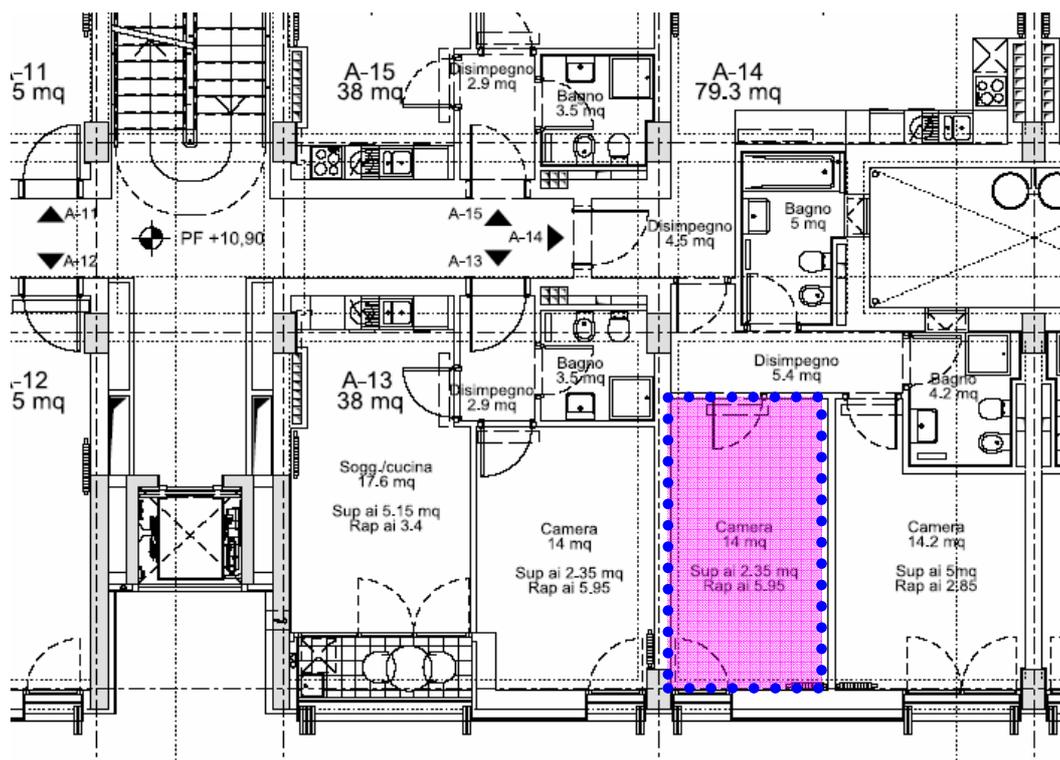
Indicazione della porzione di solaio oggetto di verifica (piano tipo)
